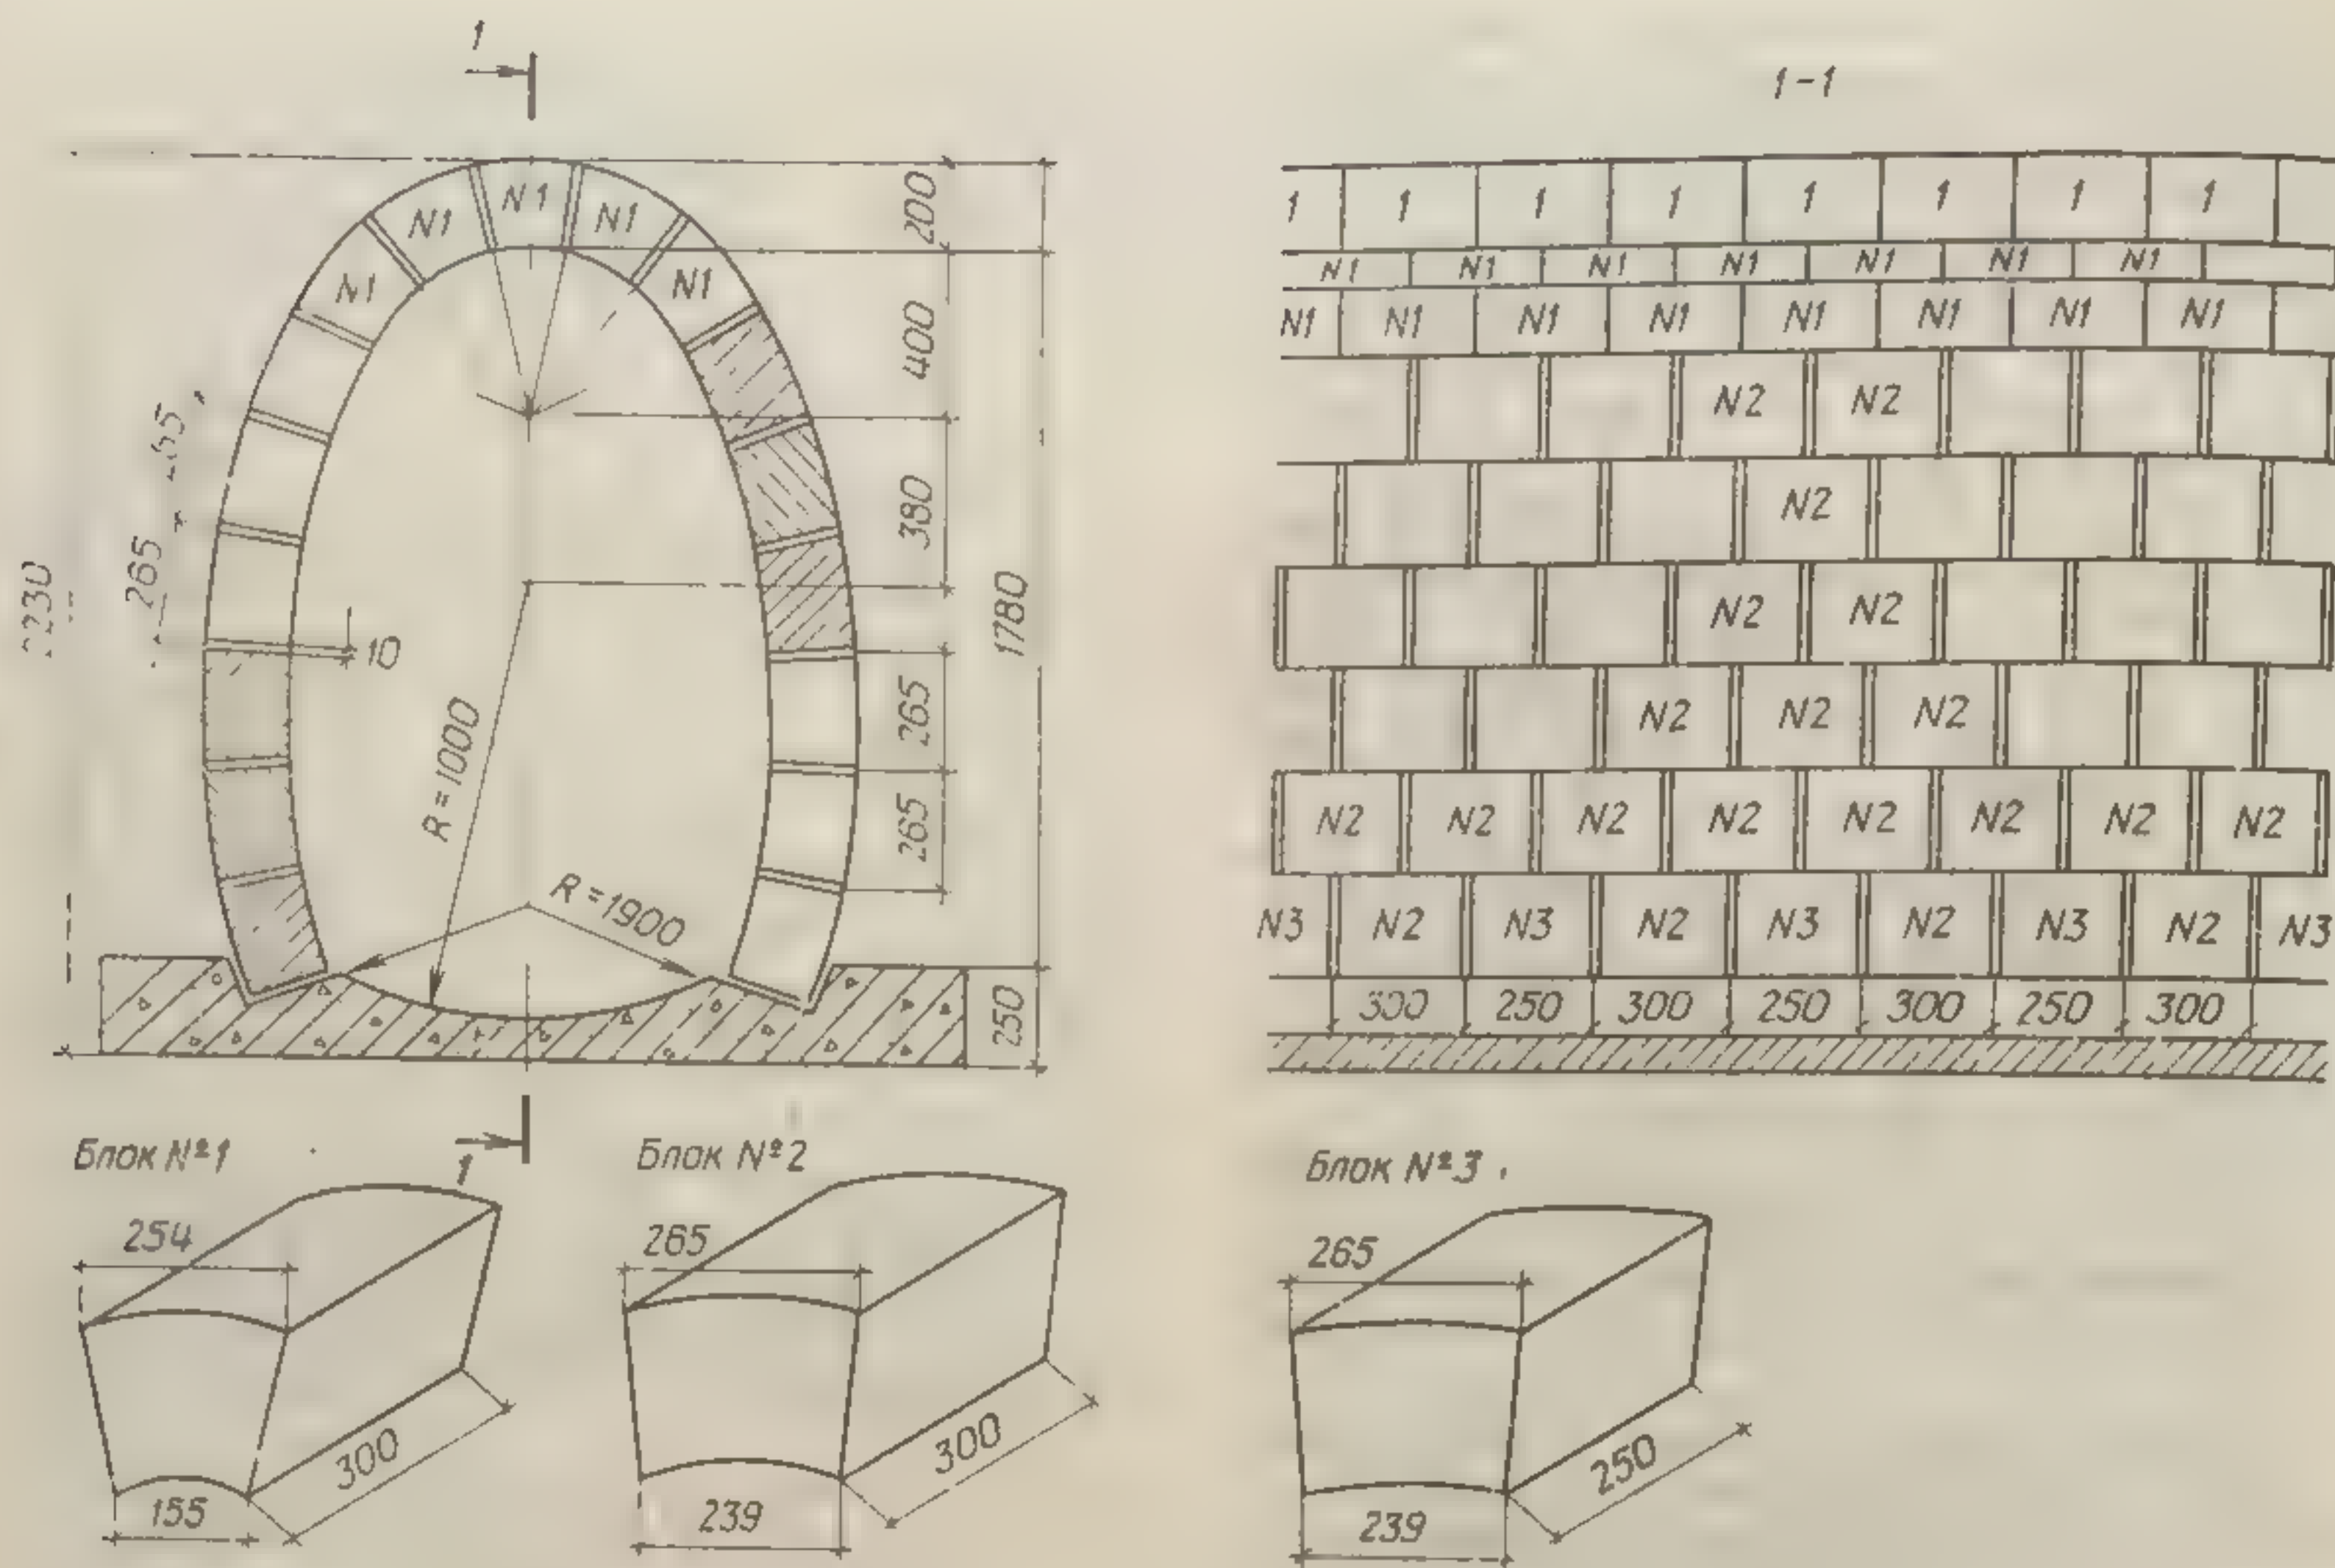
Обделка дренажной штольни из бетонных блоков
